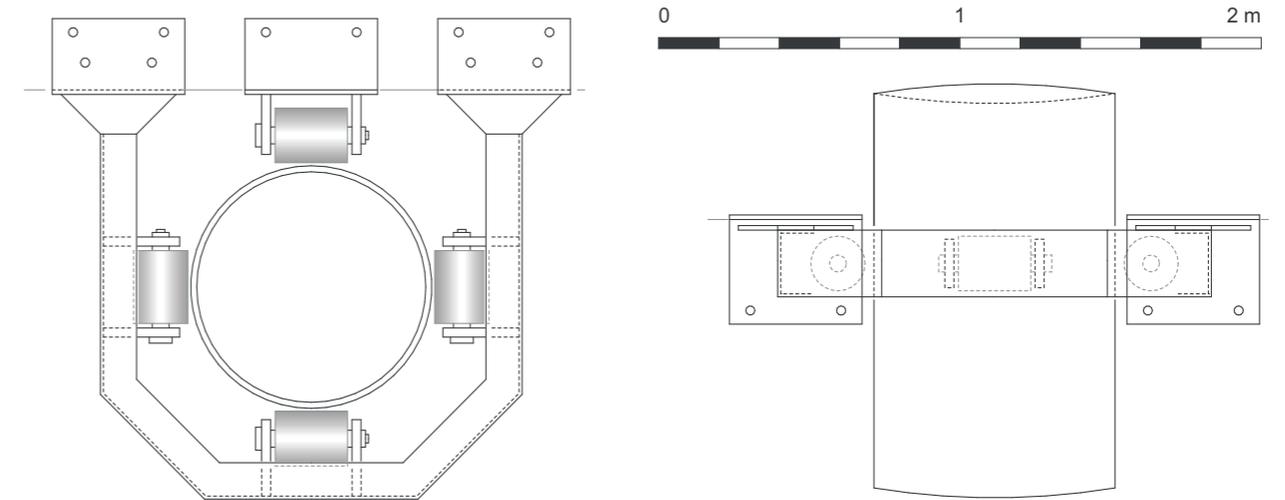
| 80 Pontonfixierung mittels Stahlpylon
